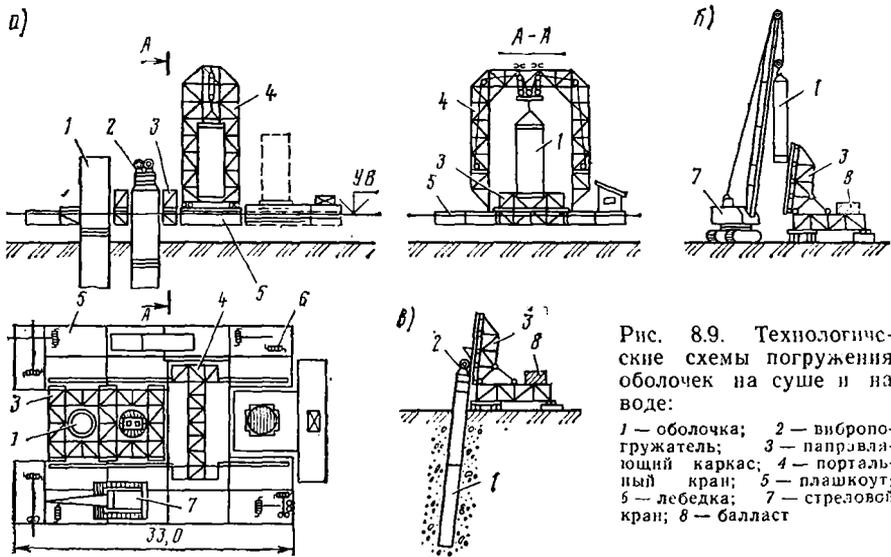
Технологические схемы погружения оболочек на суше и на воде:
